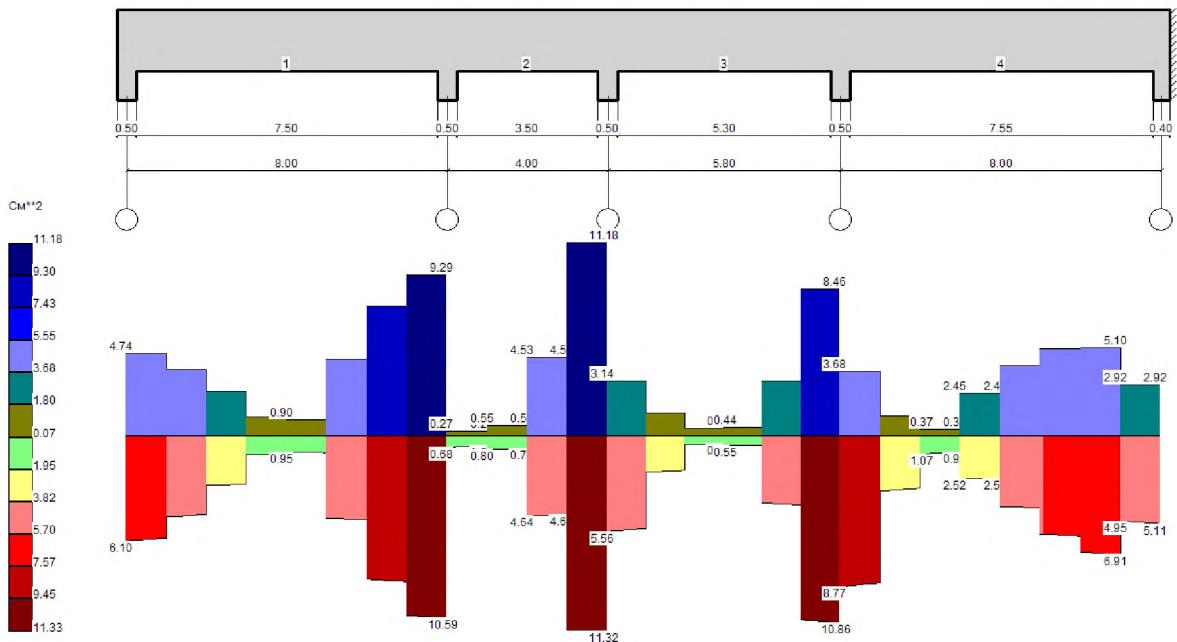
Балка № 8. Епюра поперечного армування
